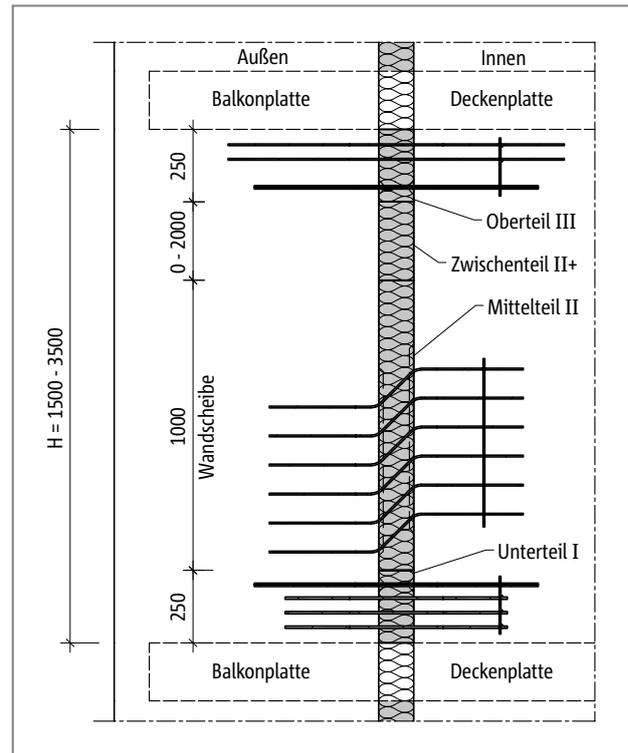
Schöck Isokorb® Typ WXT: Balkonkonstruktion mit wärmege-
